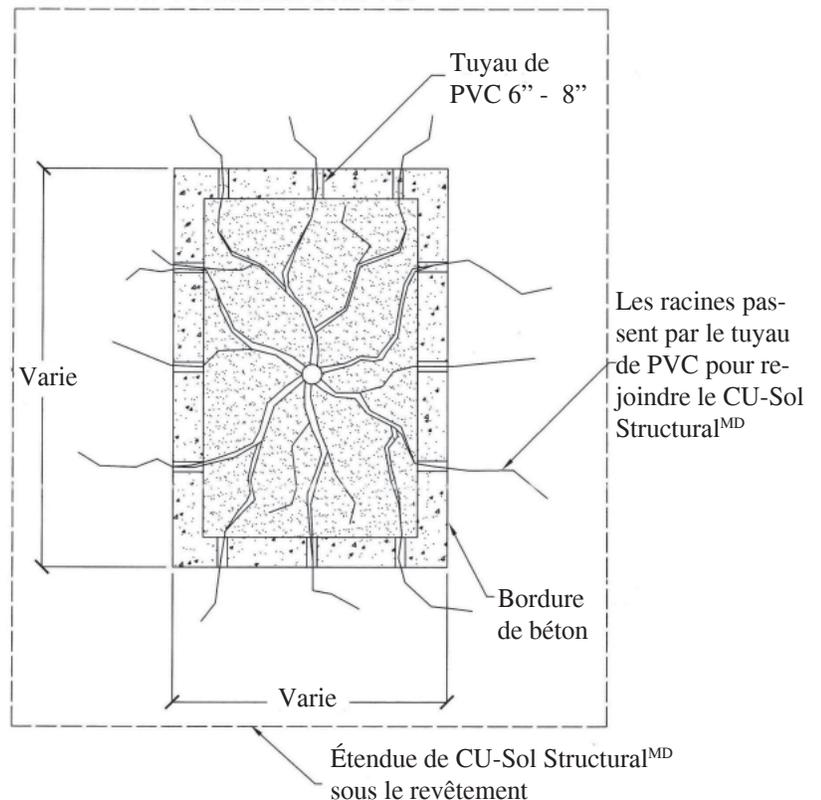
Vue en plan d'une plantation avec volume de sol restreint
